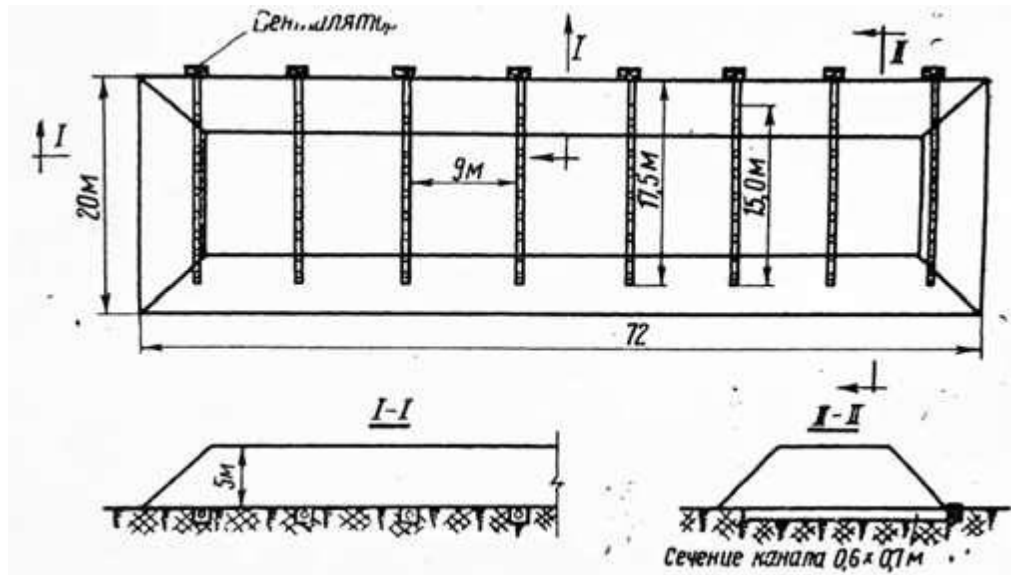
Поперечна схема розташування вентиляційних гілок
